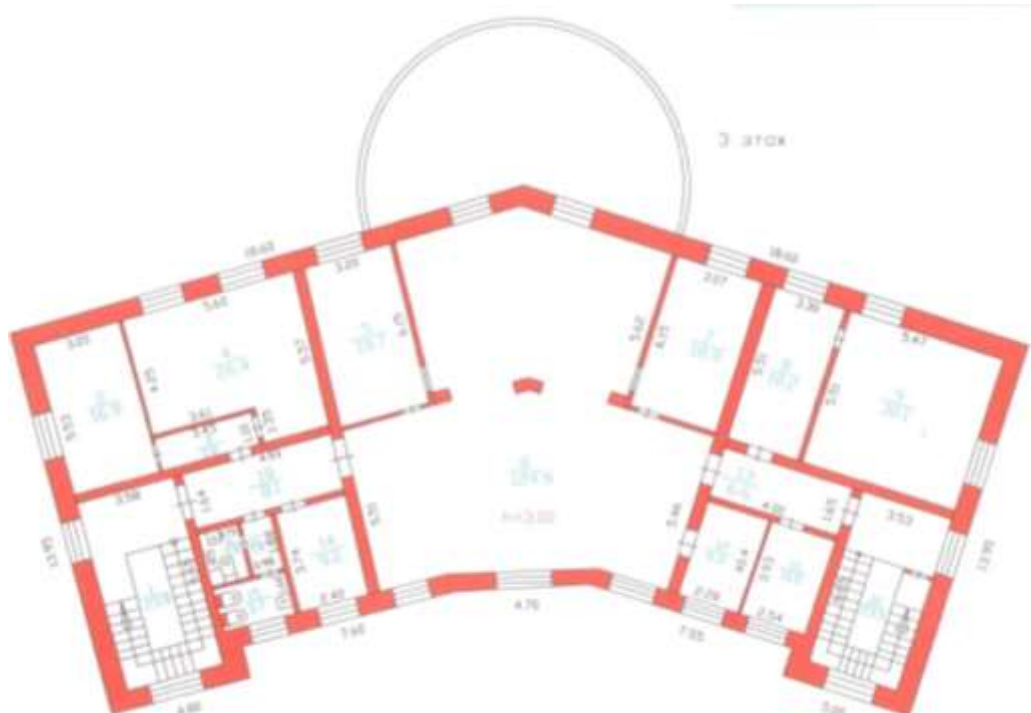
План 3 этажа здания поста ЭЦ
